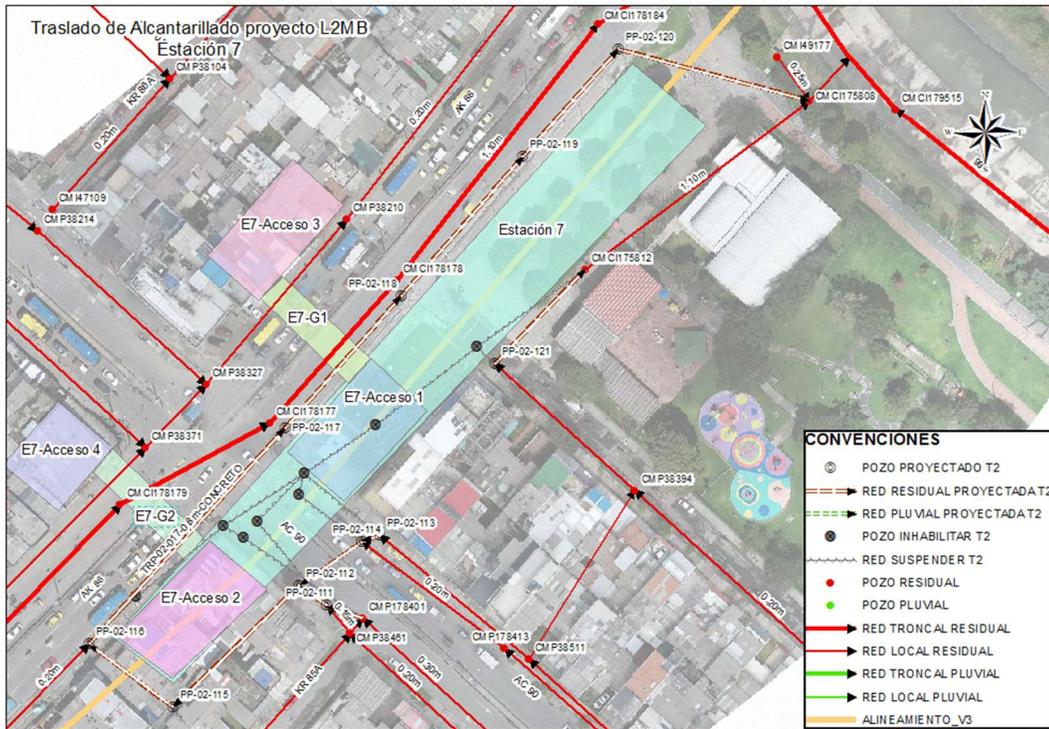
Traslado redes de alcantarillado Estación 7 Carrera 86 con calle 89A Red Residual
